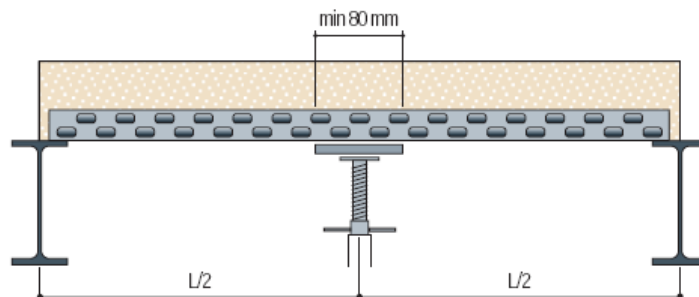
Detalle constructivo de cómo utilizar puntales cuando la chapa actúa como encofrado perdido.
